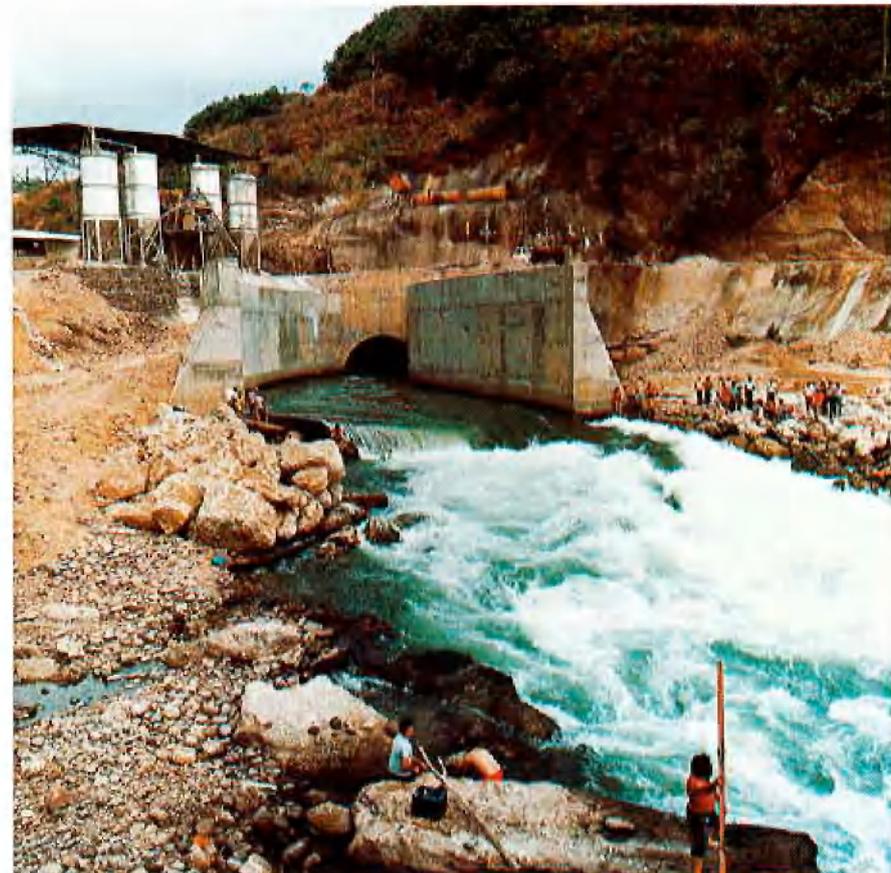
Einlaufbauwerk, im Vordergrund Grundablaßstollen und Einlaufsturm
